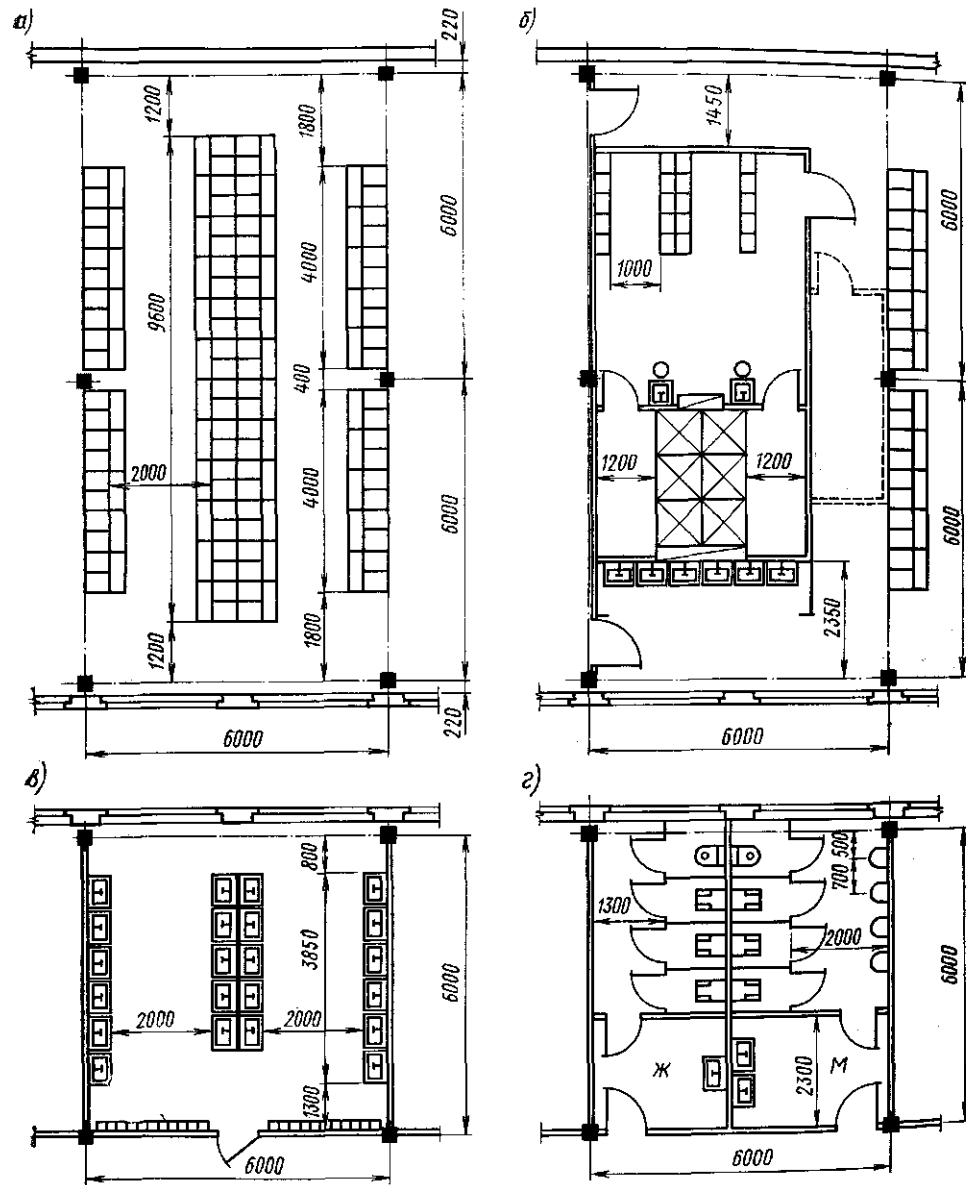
Примеры планировок отдельных бытовых помещений:
